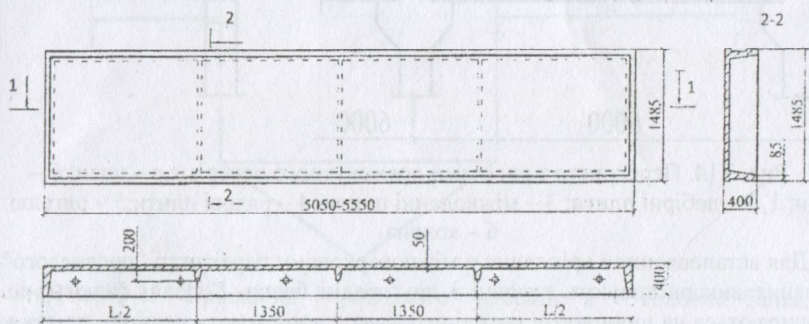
Залізобетонна ребриста плита перекриття для ригелів з полицями
